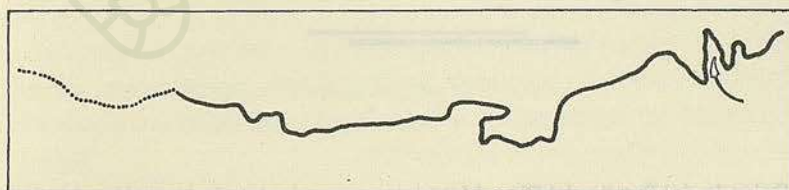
Calzada del Puerto del Pico. El Portazgo.
